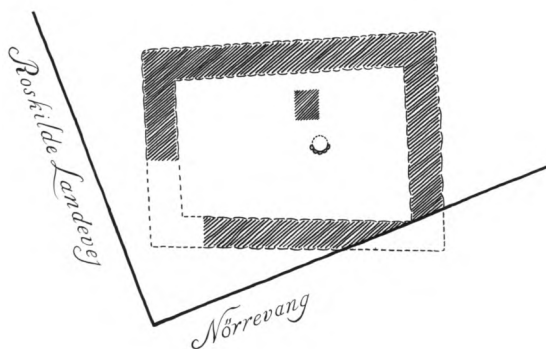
†Kapel ved Roskildevej. Plan 1:300. Målt og tegnet af Peter Linde 1929. - †Chapel on Roskildevej, the main road to Roskilde. Ground-plan.
